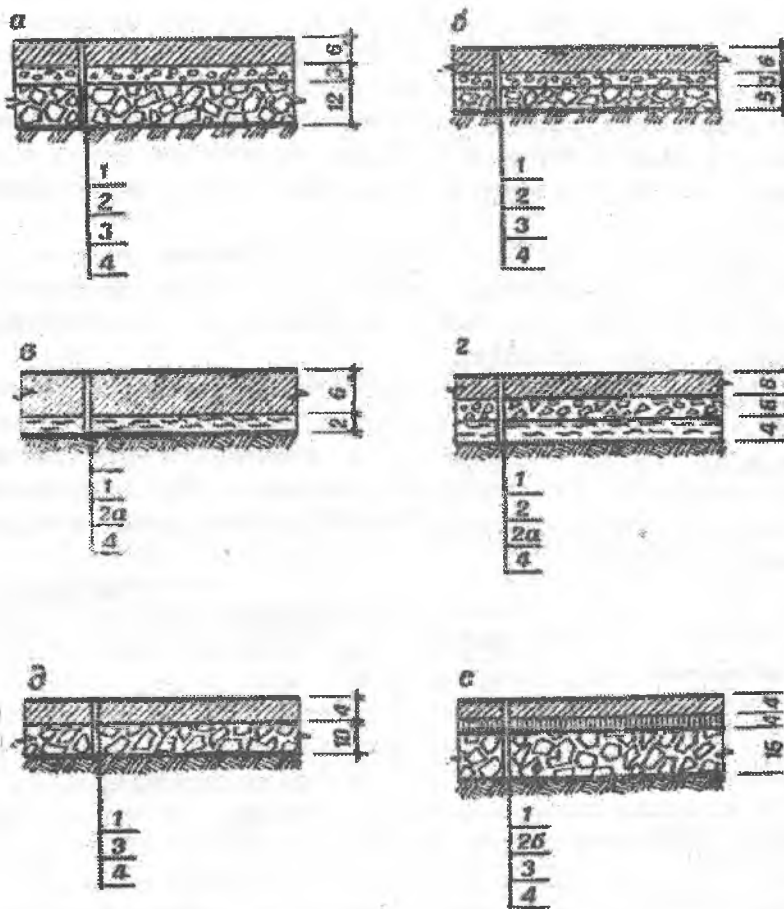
Конструкции спортивных площадок со специальным покрытием
